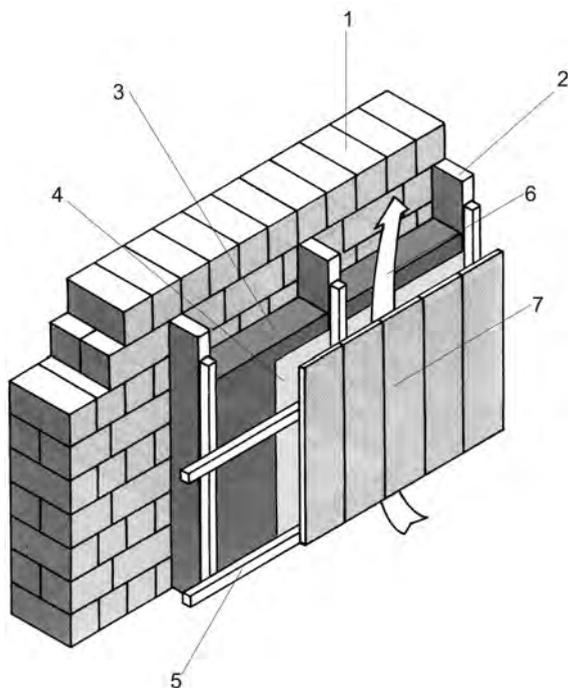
Навесной фасад с системой выходных вентиляционных каналов: 1 — наружная стена; 2 — вертикальные деревянные рейки; 3 — теплоизоляционные плиты; 4 — диффузионно-проницаемый лист; 5 — деревянная обрешетка; 6 — вентилируемый воздушный зазор; 7 — наружная деревянная обшивка
